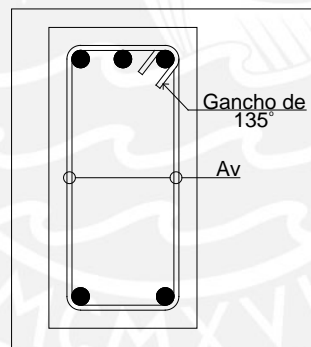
Detalle de estribo cerrado con gancho estándar de 135°.
